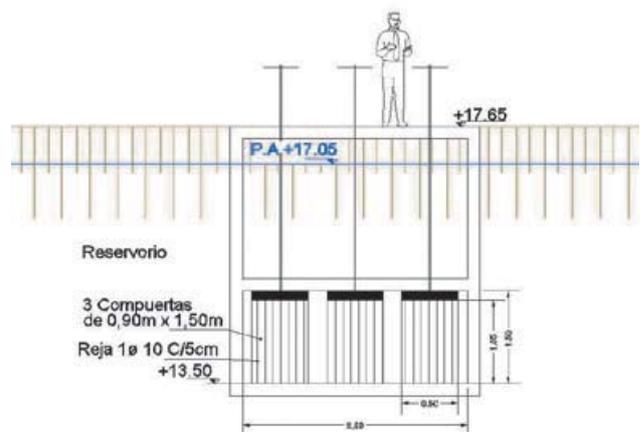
Conducto de ingreso canal intermedio. (Fuente propia).
